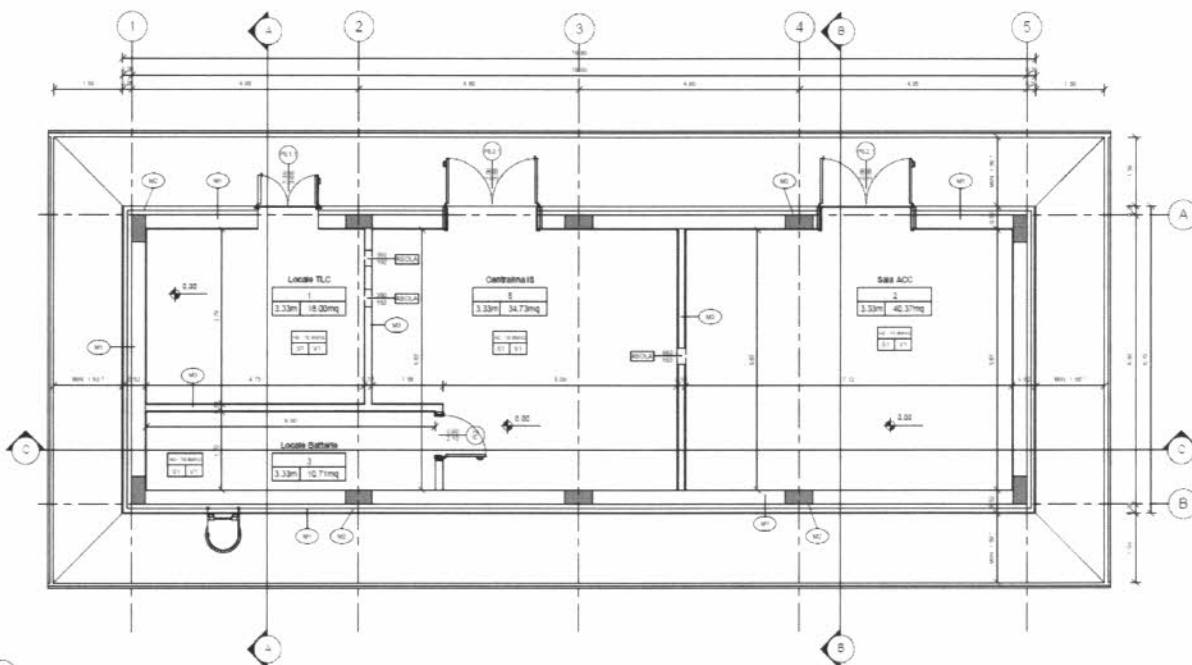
Pianta Architettonica Piano Terra – Layout T4.A
